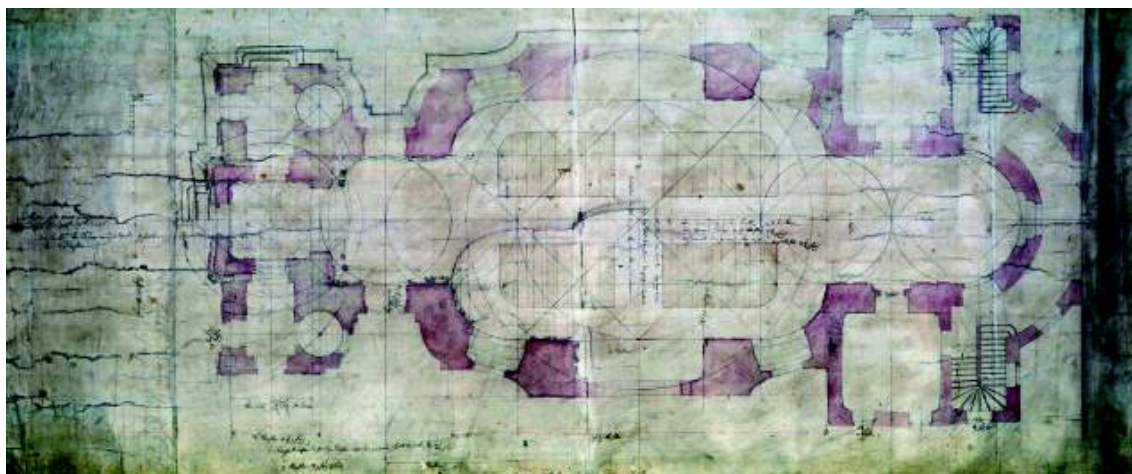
Plan original (înainte de 1769) – plan parter al bisericii piariste din Carei
